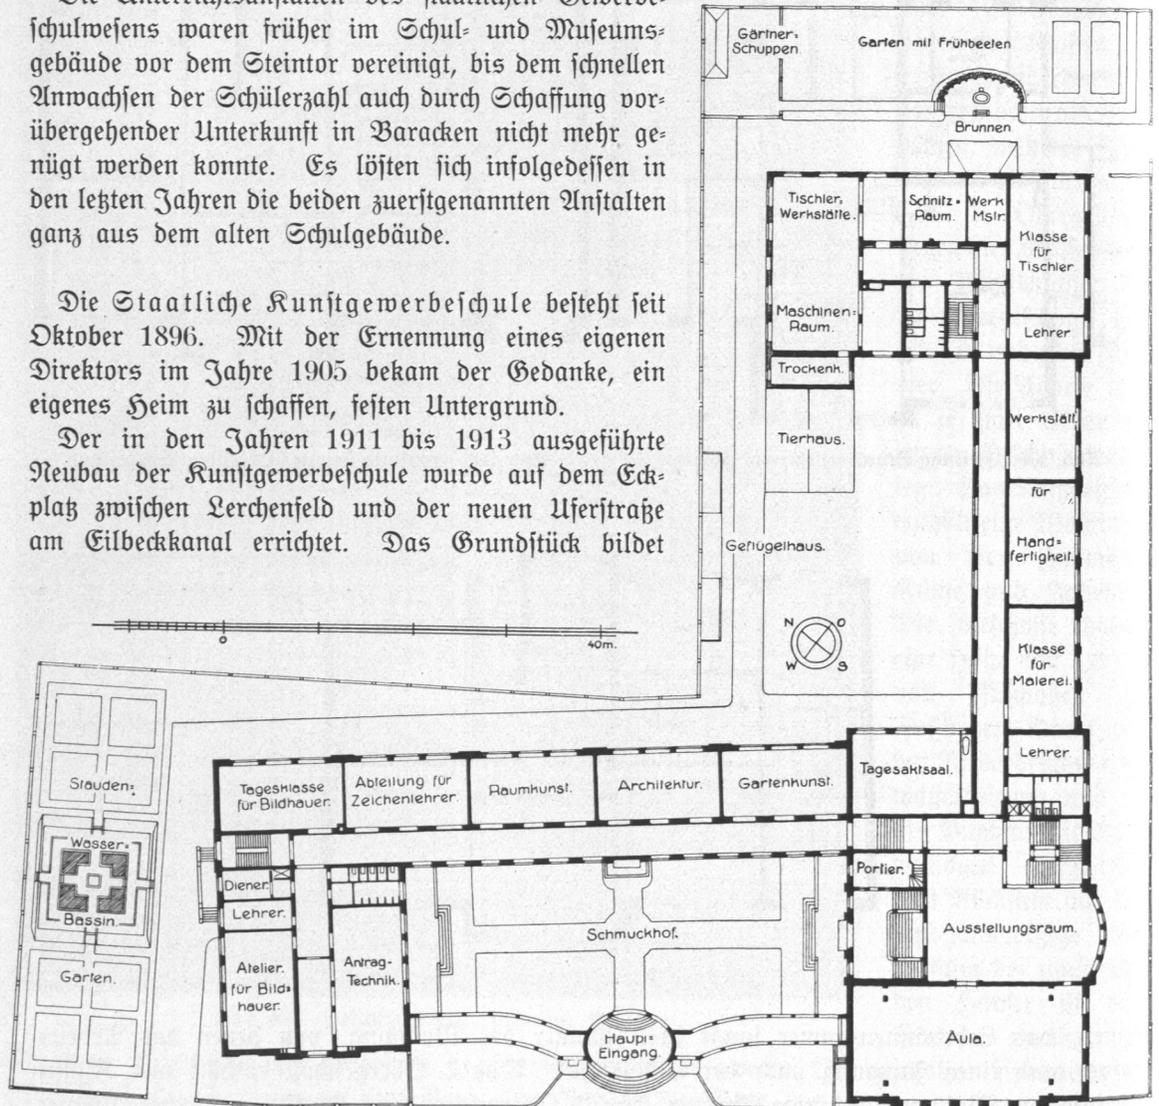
Staatliche Kunstgewerbeschule, Erdgeschoß, Grundriß.
